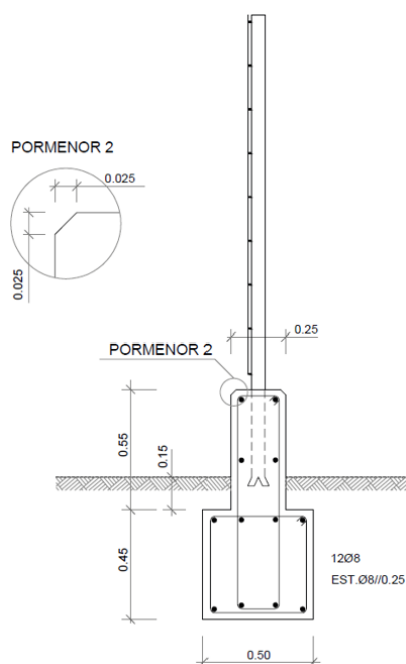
Geometria e pormenorização de armaduras no murete de apoio
